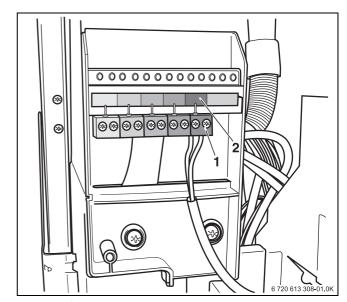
Stecker für Warmwasser-Temperaturfühler aufstecken
